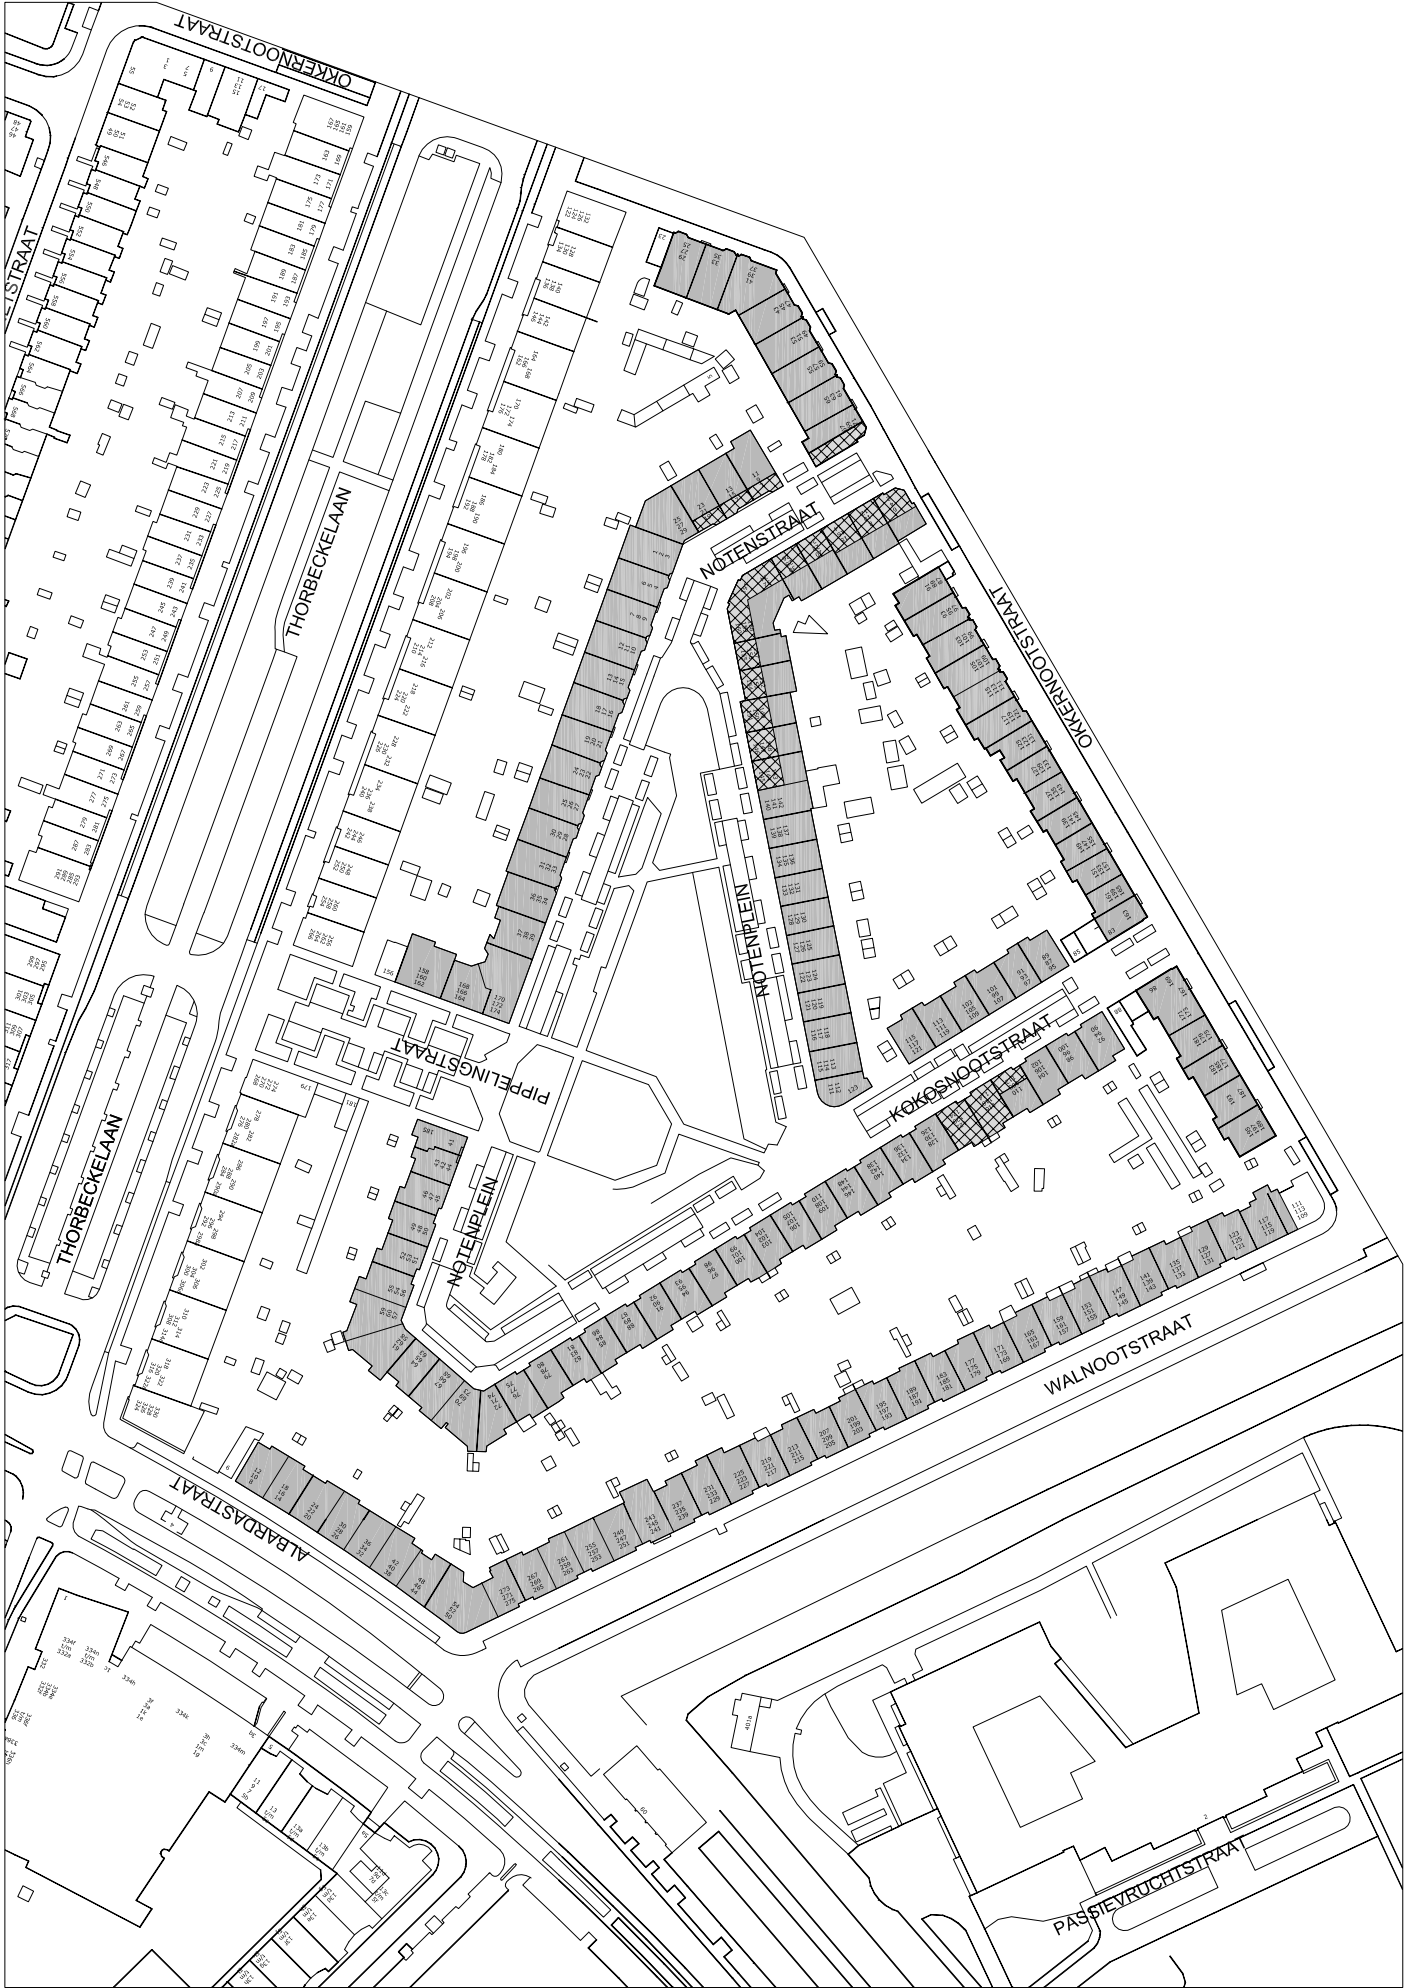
situatietekening noordelijk plandeel met onderzochte woningen en locaties waarnemepunten
